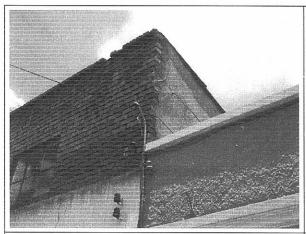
Muro de fachada en segundo nivel y culata costado sur en buen estado
